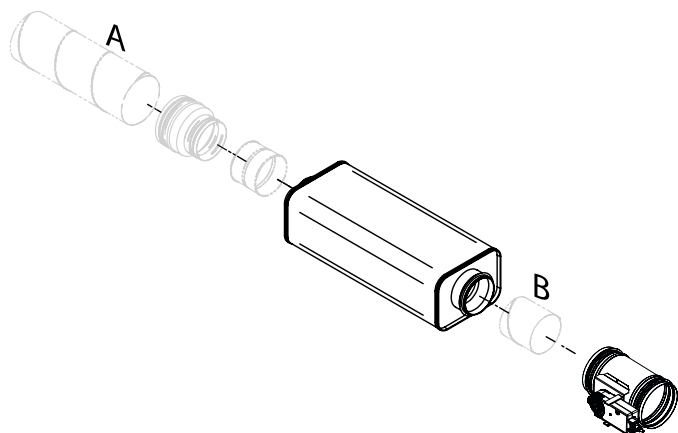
Kit d'air soufflé, PARAGON T-SAK-VAV-100
